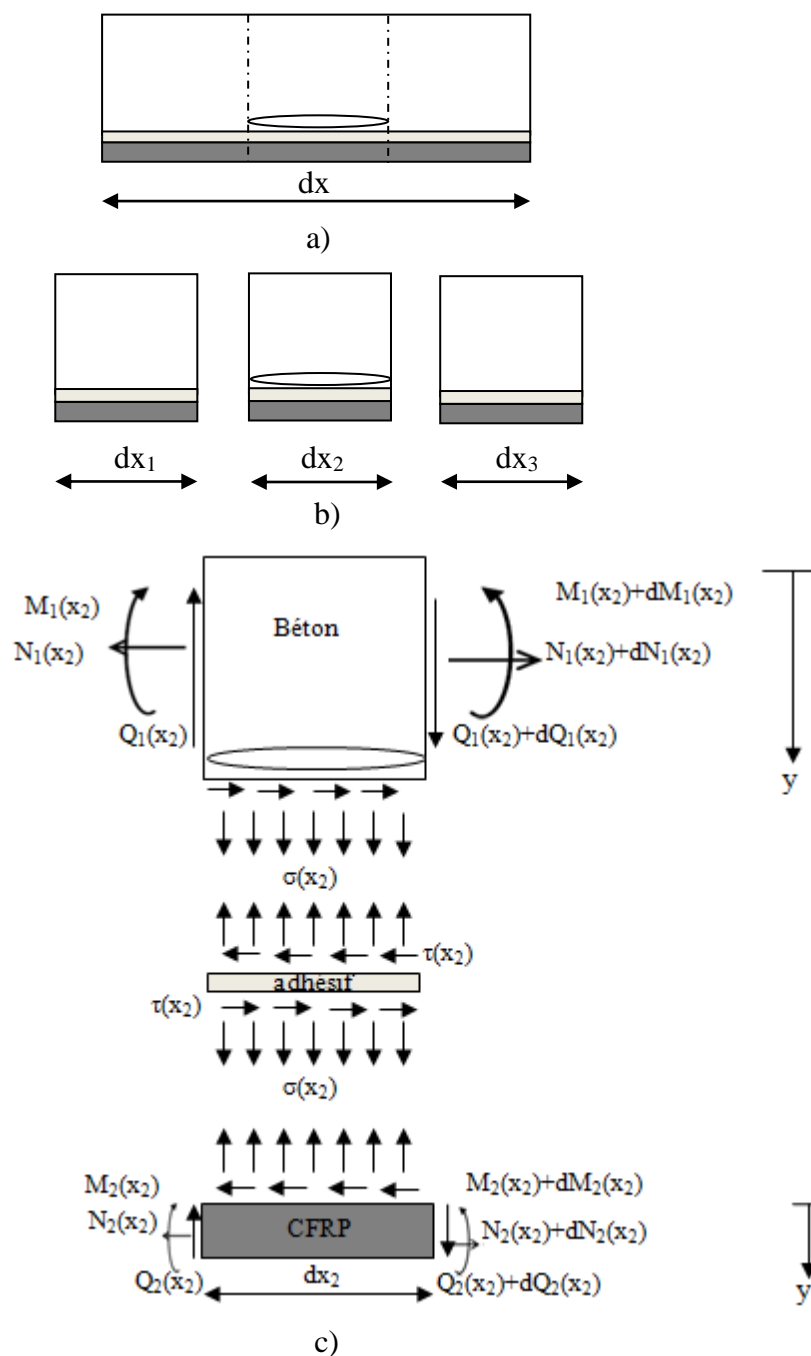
a) Poutre fissurée réparée par plaque en CFRP, b) Décomposition de la poutre fissurée, c) Les forces internes des éléments de la poutre renforcée- fissurée.
